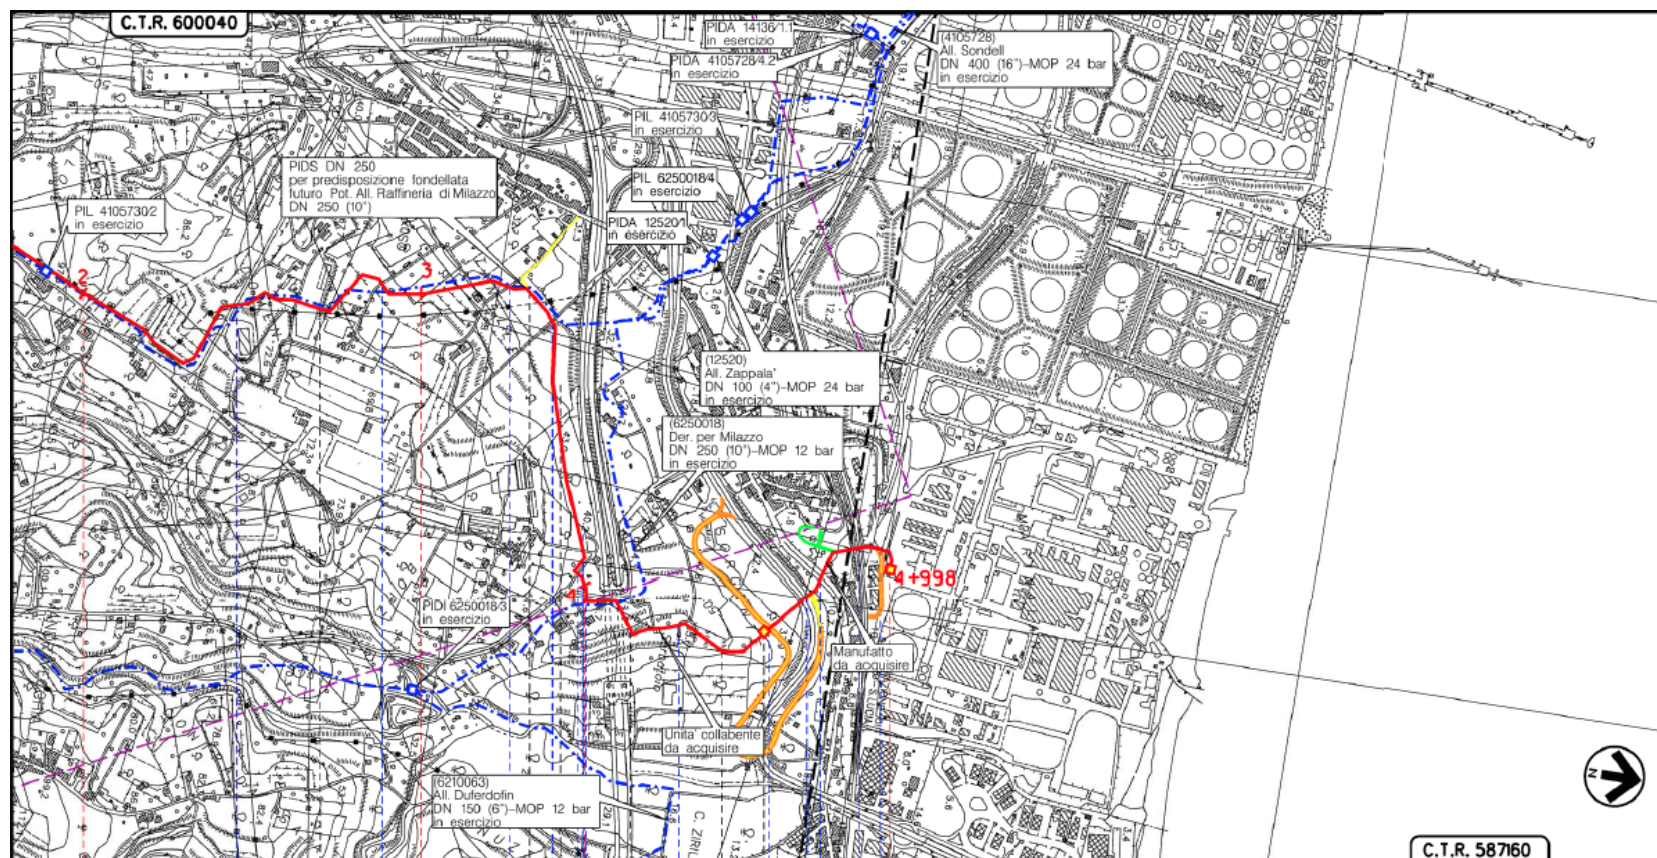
Stralcio planimetria CTR con localizzazione dell'area di intervento
